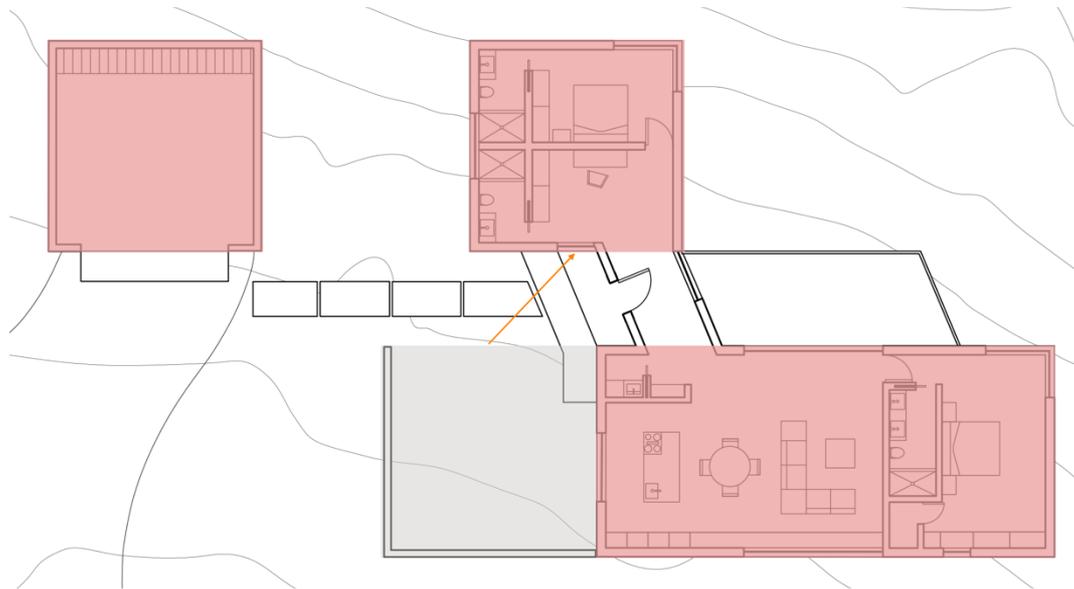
Masterplan de la Casa Paseo Encantado en Tesuque
